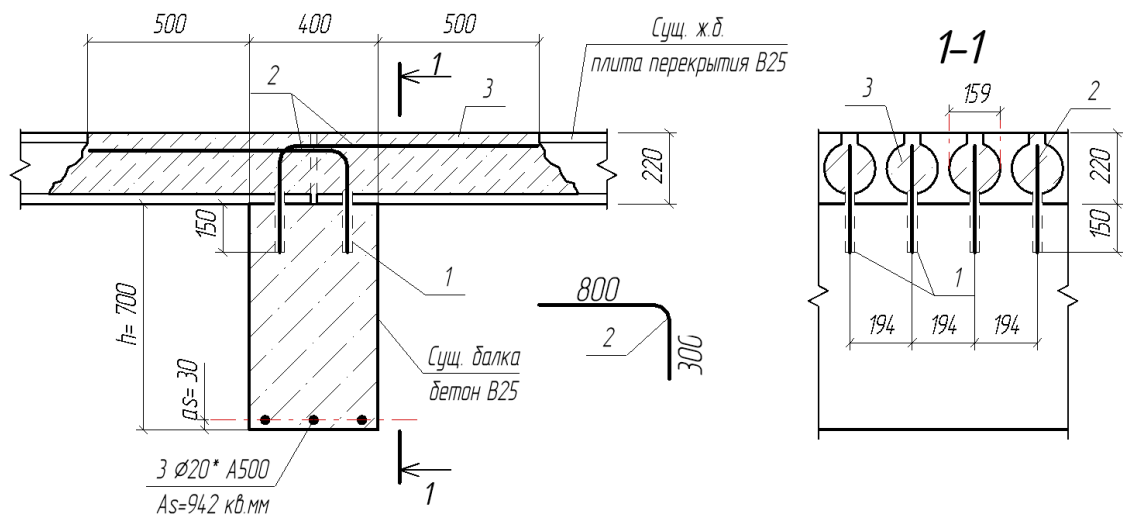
Усиление существующей ж.б. балки прямоугольного профиля, заменой его на тавровый профиль путем заполнения бетоном приопорных участков плит перекрытий.
